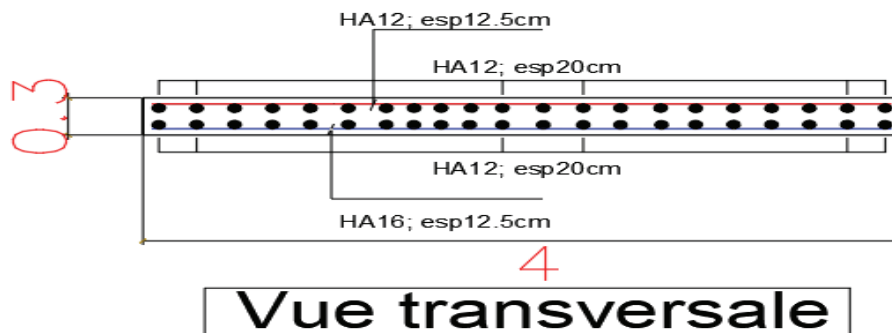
La coupe transversale du ferraillage de la dalle de transition
